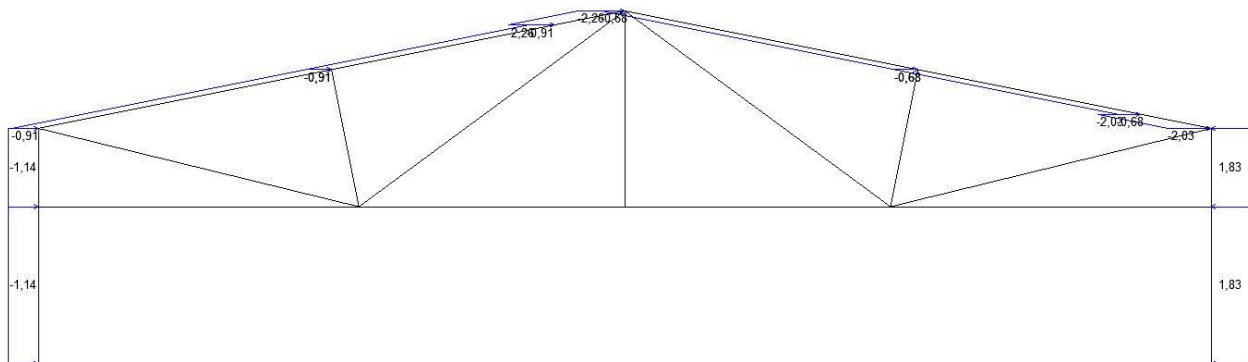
Ветровая нагрузка на ферму и колонну, вариант 1
